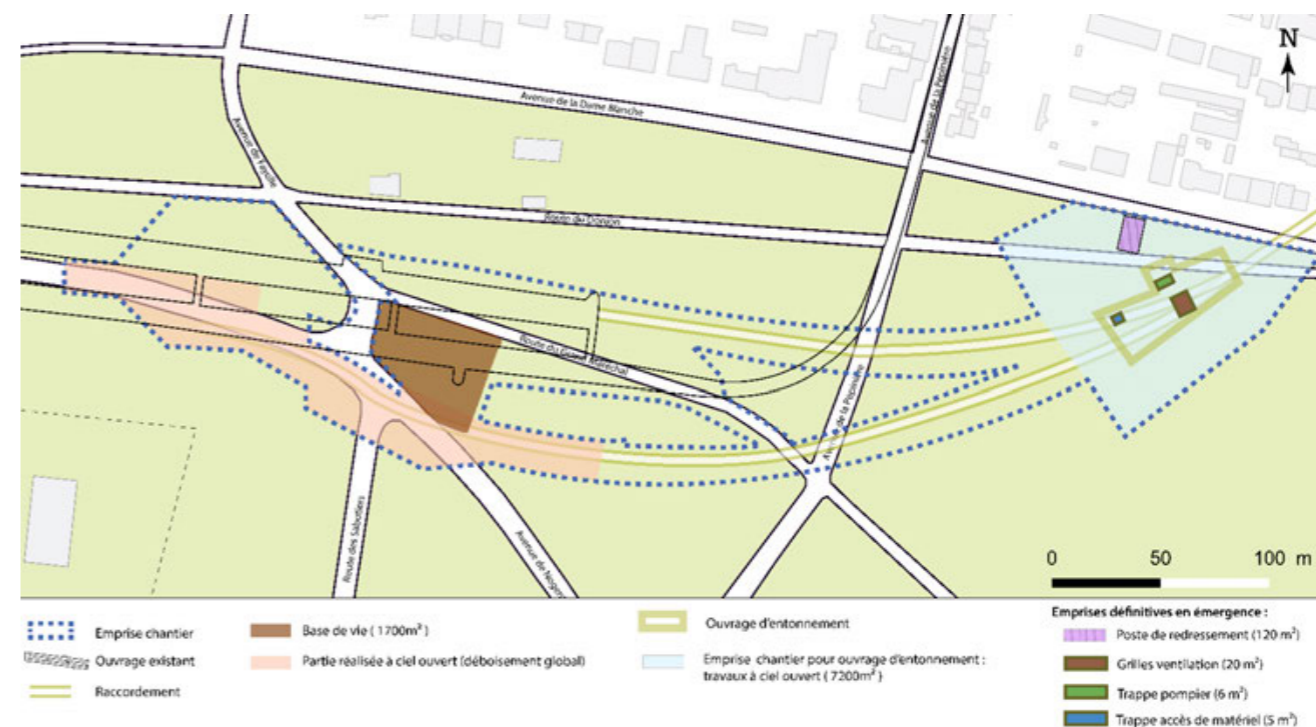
Emprise chantier pour le raccordement du projet à l'existant (Sources : RATP / INGEROP)
